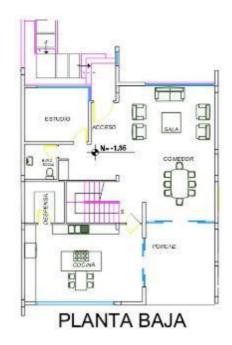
Casa 2 - planta baja Elaborado por: Carolina Calupiña M
